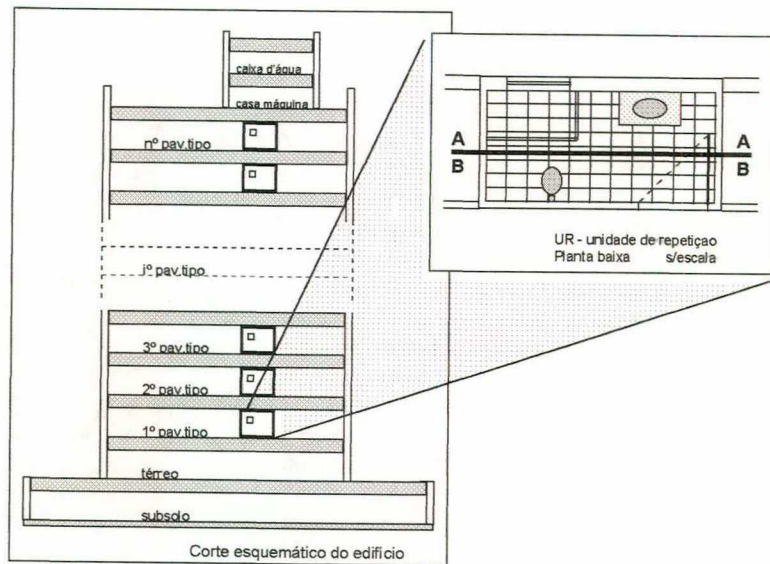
Corte esquemático do edifício e planta da unidade de repetição
